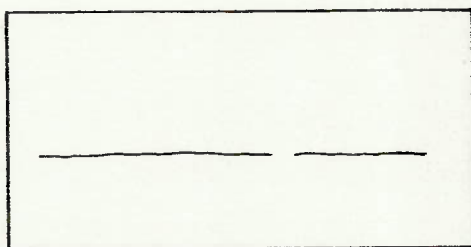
Trincas horizontais na alvenaria provenientes de sobrecarga
